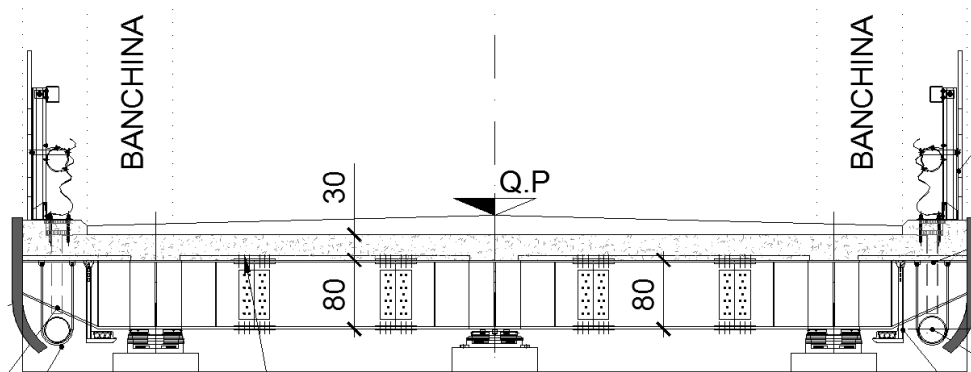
Sezione trasversale dell'impalcato campate laterali
